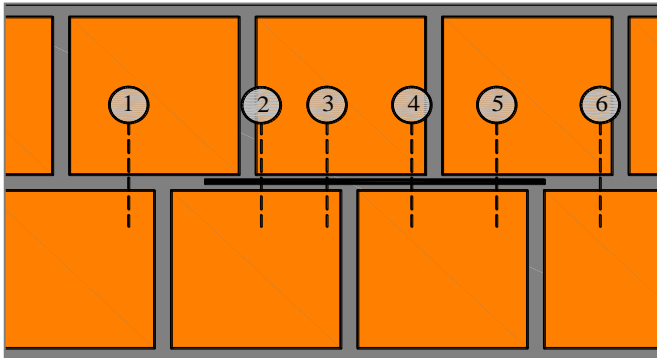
Ensaio B: vista longitudinal da posição do macaco plano, das miras de leitura e das juntas horizontais e verticais
